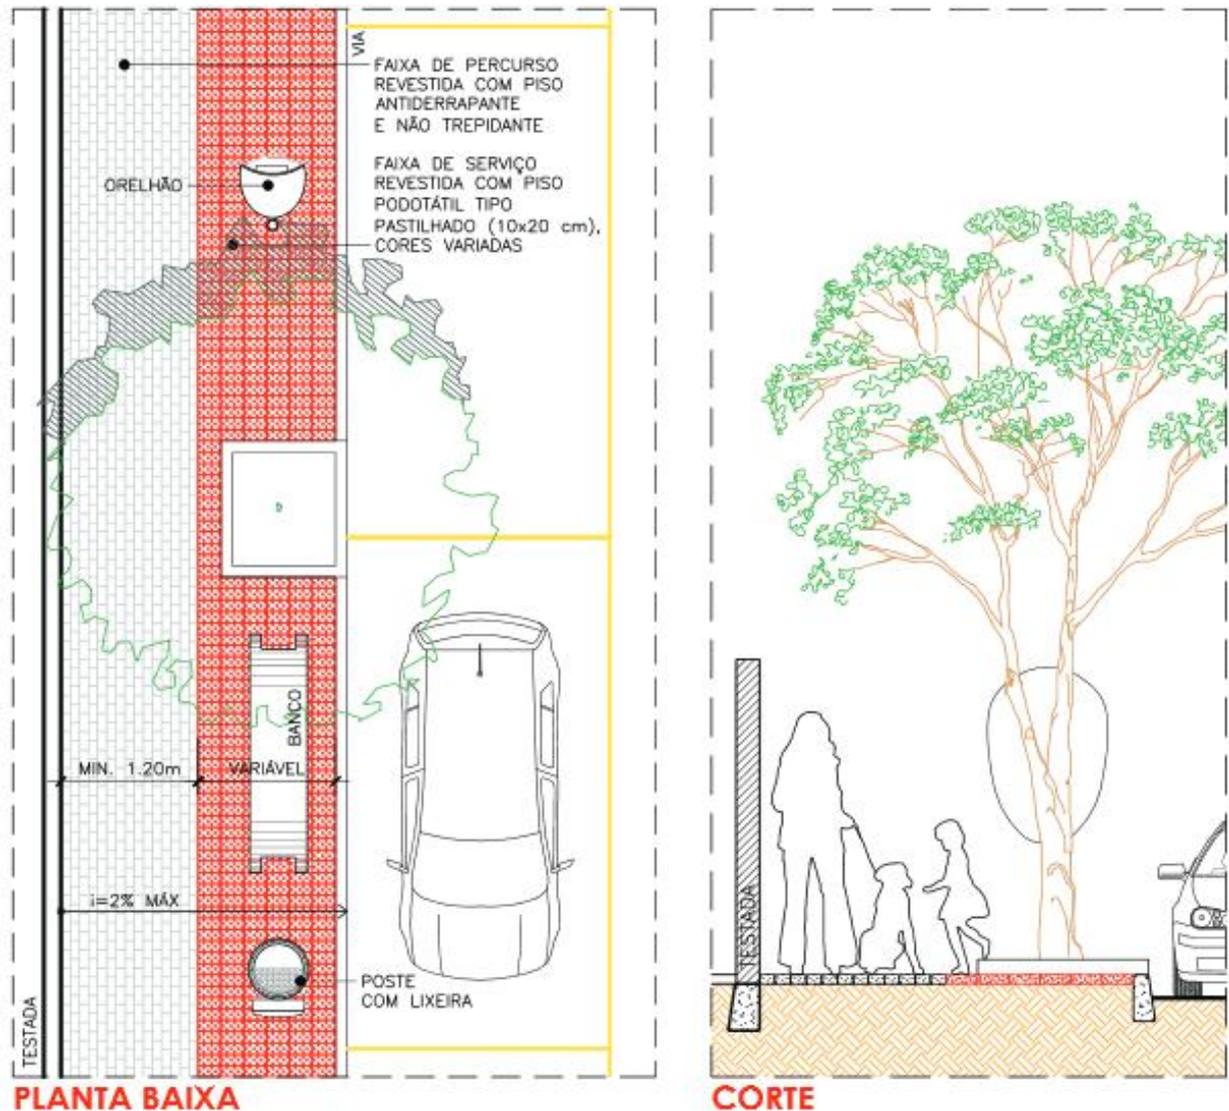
Planta baixa e corte de modelo de calçada acima de 2,00m de largura.
